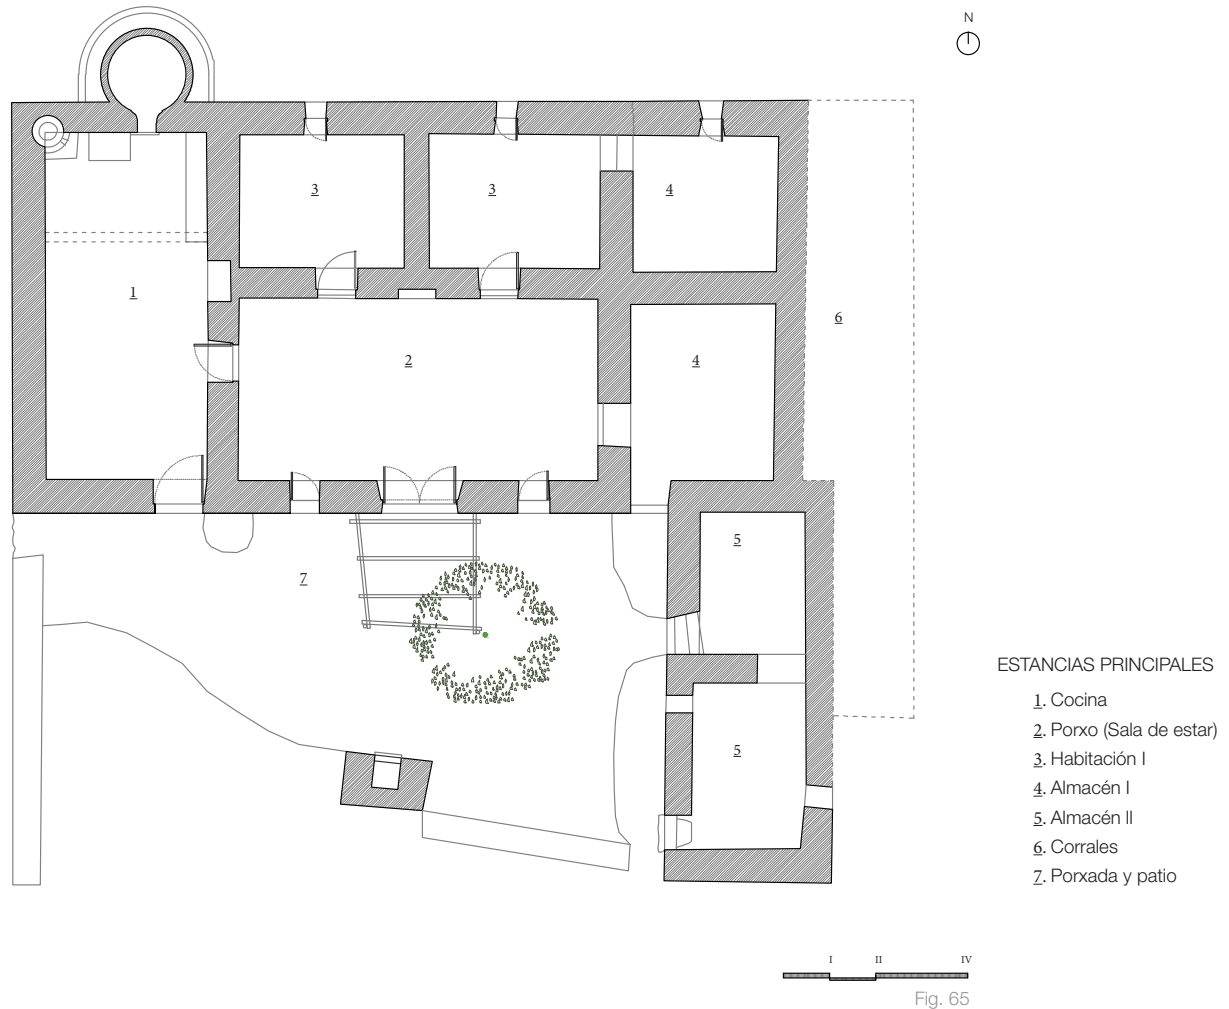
Planta de la vivienda Can Toni d'en Jaume Negre
